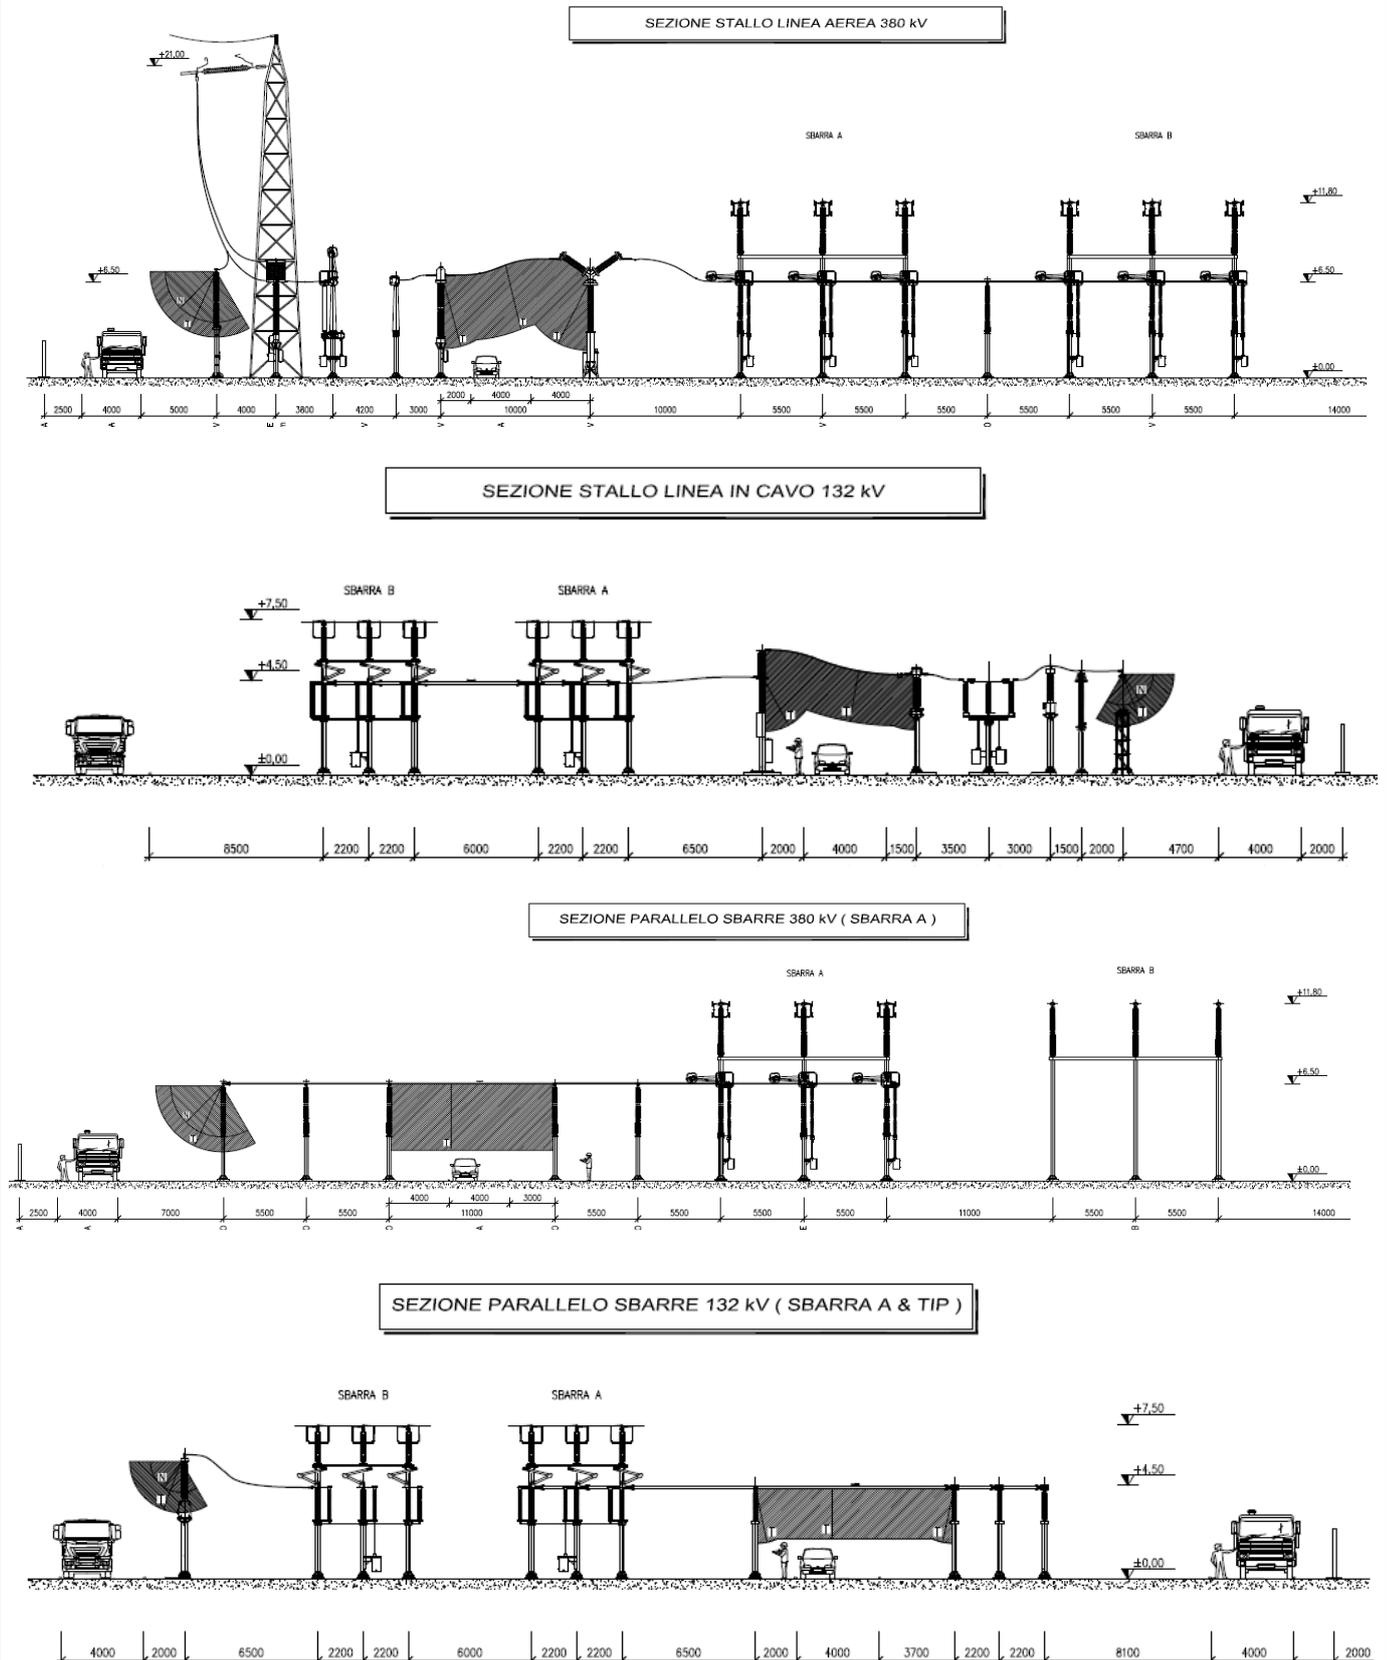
Sezioni degli stalli linea e delle sbarre delle due sezioni della stazione
